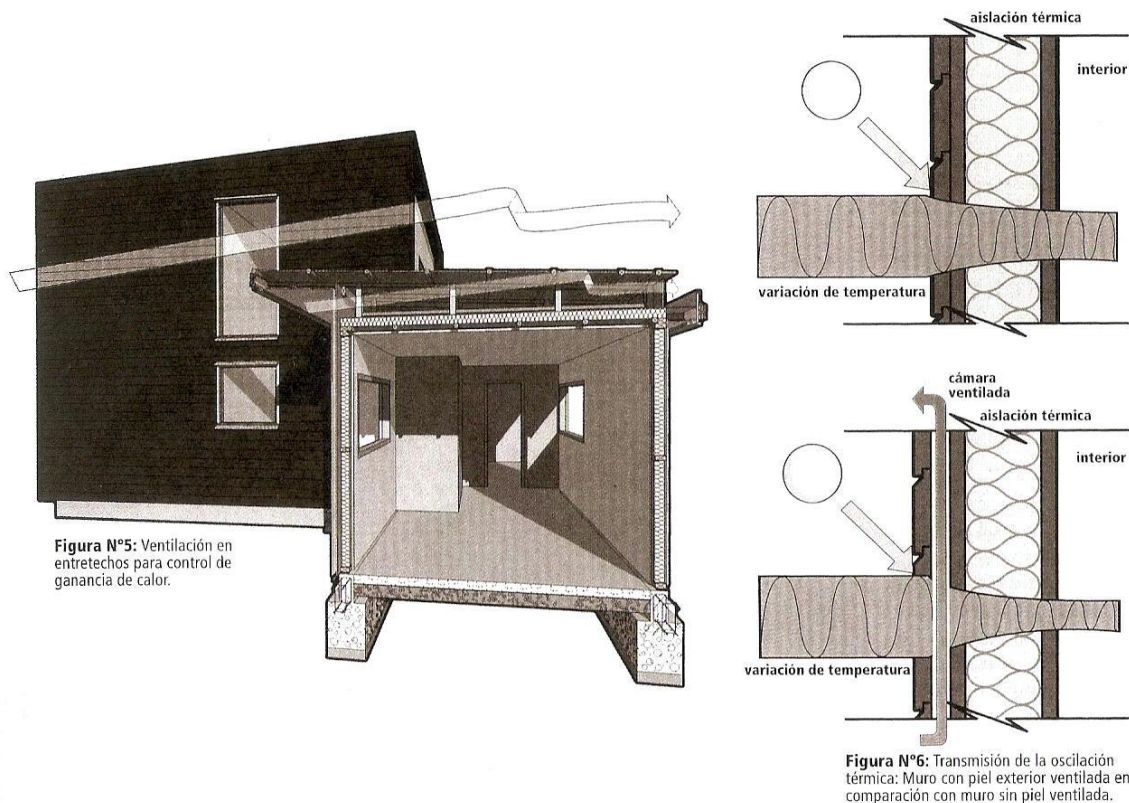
Esquemas de ventilação e câmara ventilada
